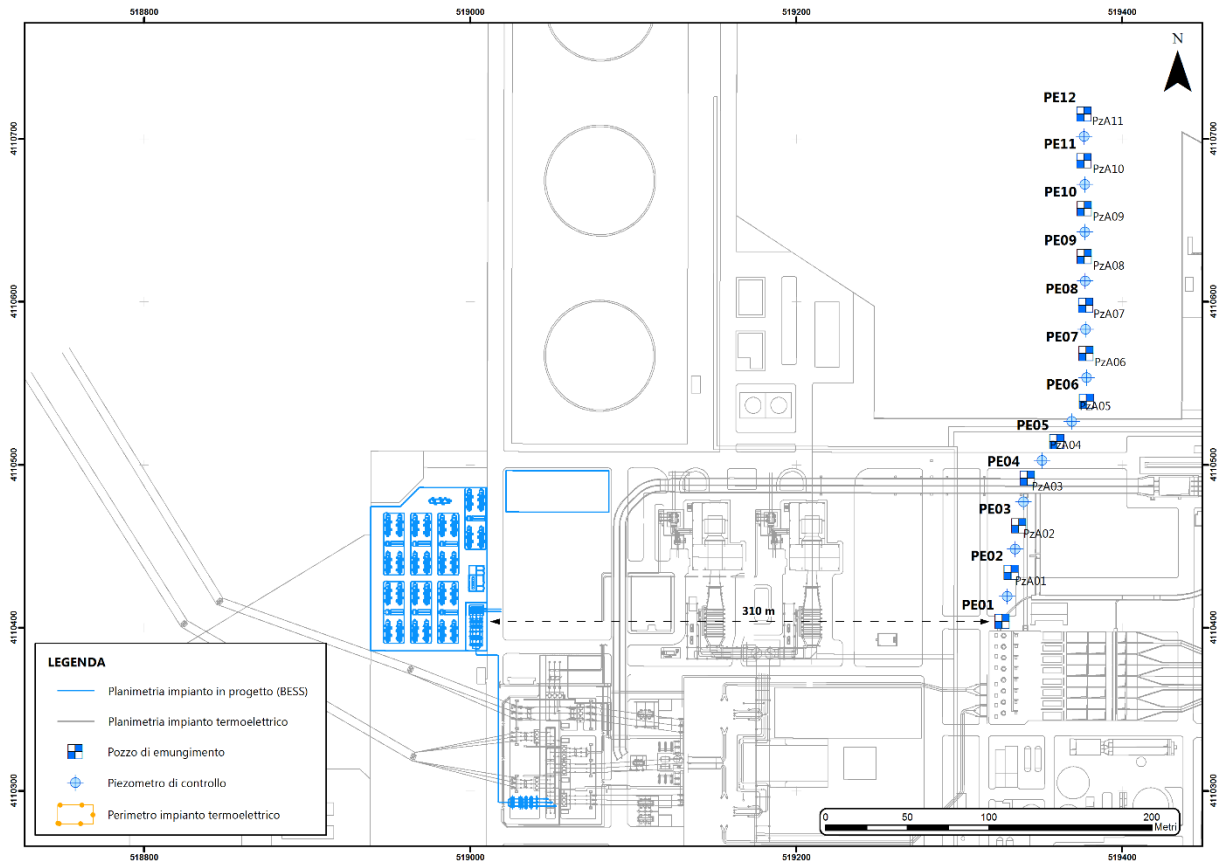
Ubicazione della barriera idraulica in progetto in relazione alla collocazione dell'area d'intervento.
